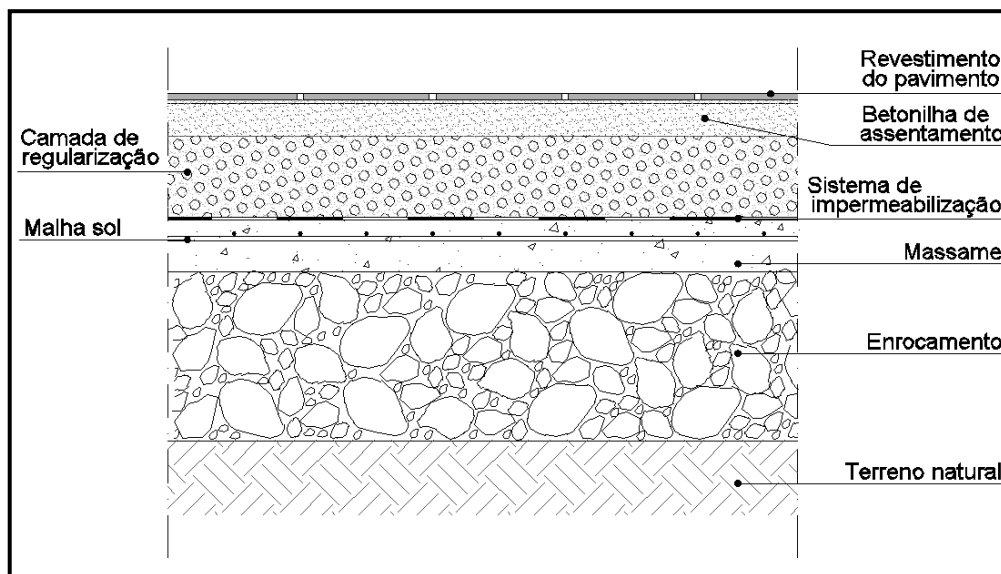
Pormenor do pavimento térreo da cave, sobre o terreno, em corte
